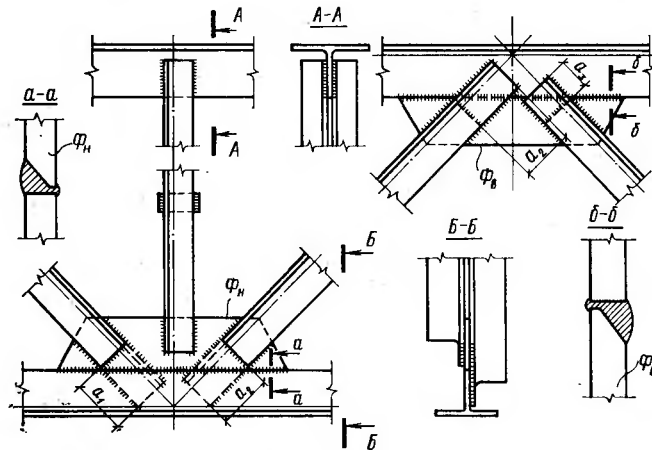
Узлы стропильной фермы с решеткой из парных уголков
